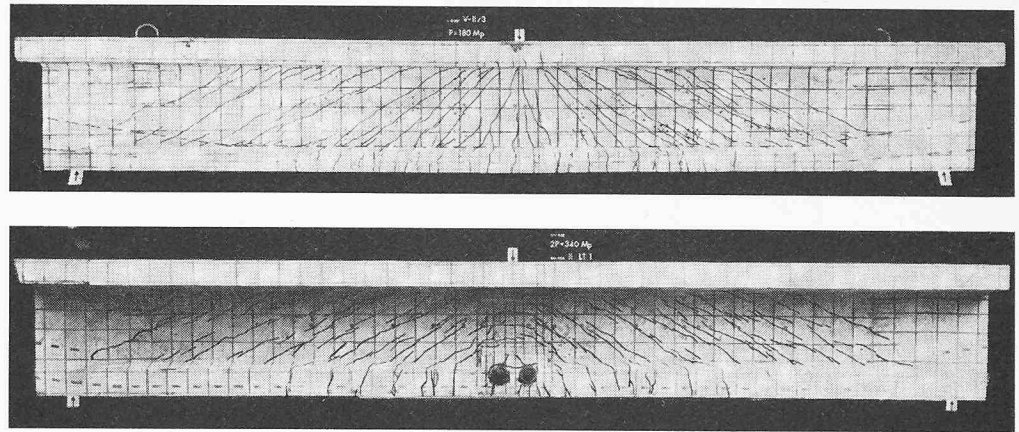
Rissbilder direkt belasteter Spannbetonträger (oben) und indirekt belasteter Spannbetonträger (unten)
